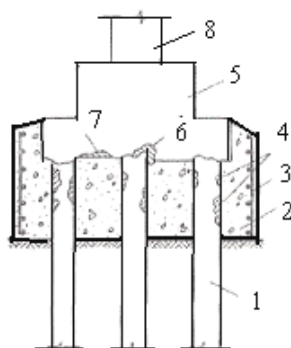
Схема усиления верхних концов свай железобетонной обоймой:
